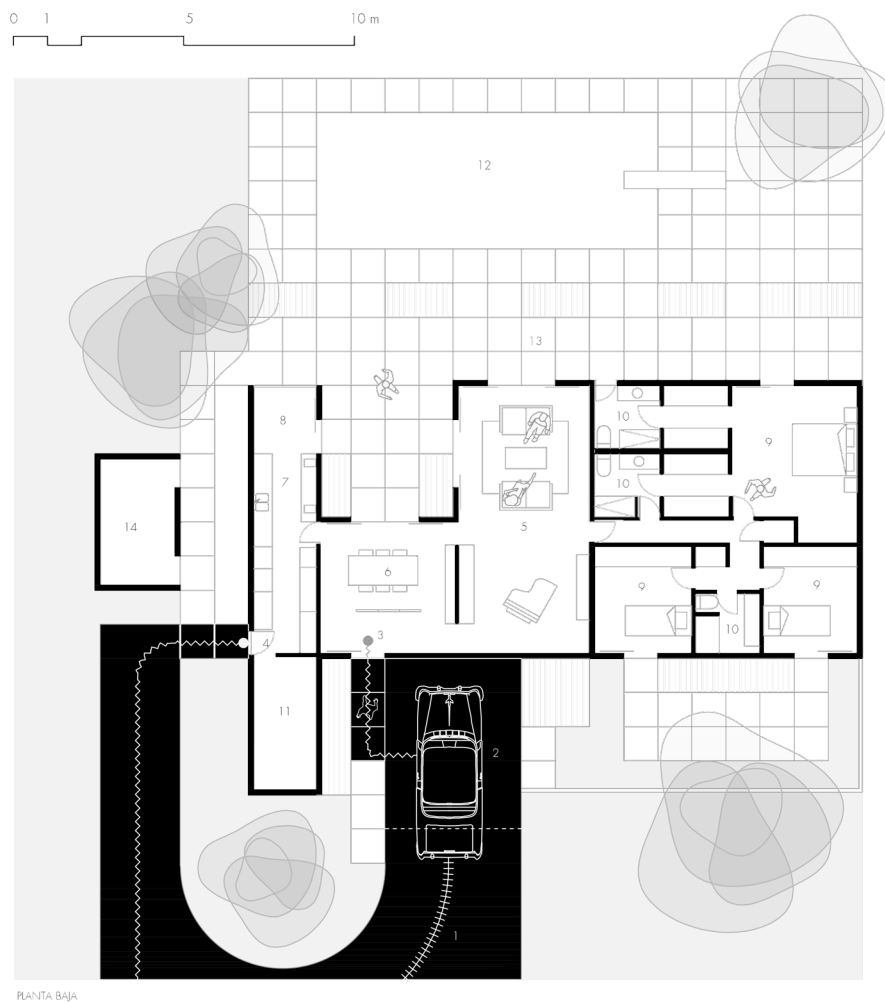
(pag sig): Planta *Case Study House N°18*, Craig Ellwood, 1956-1958. Dibujo de la autora.
